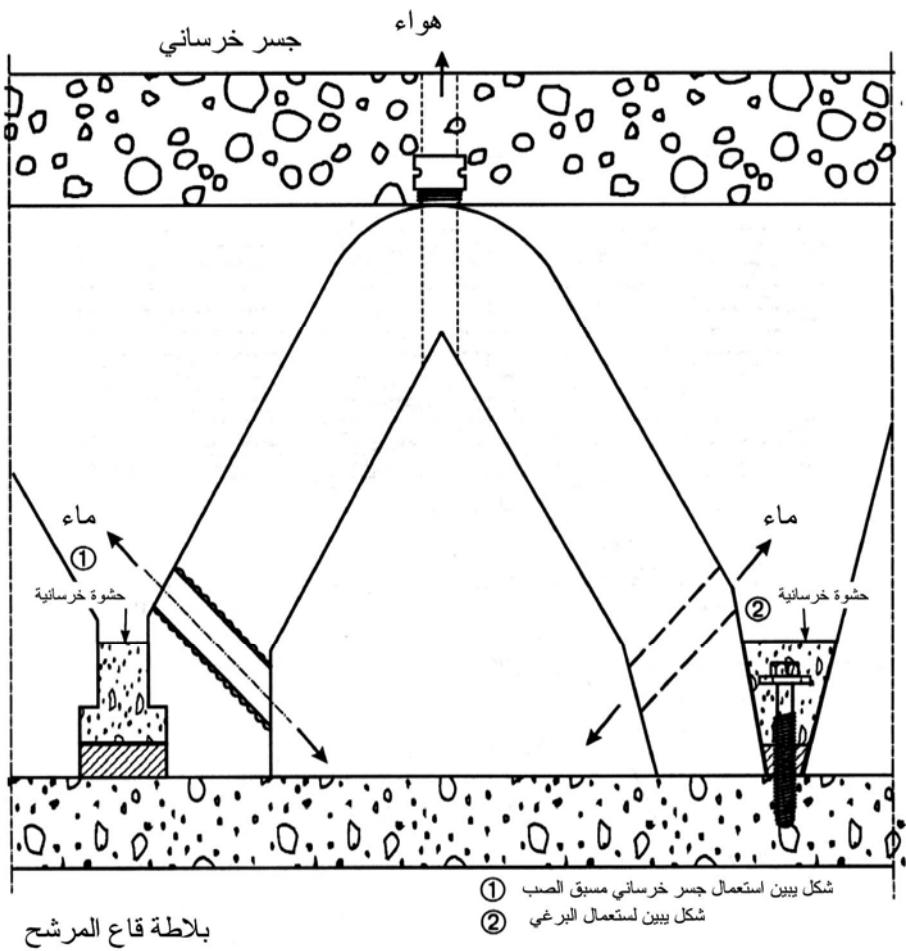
مسقط أفقي لقاع مرشح متموج واتجاه جريان مياه الغسيل العكسي
